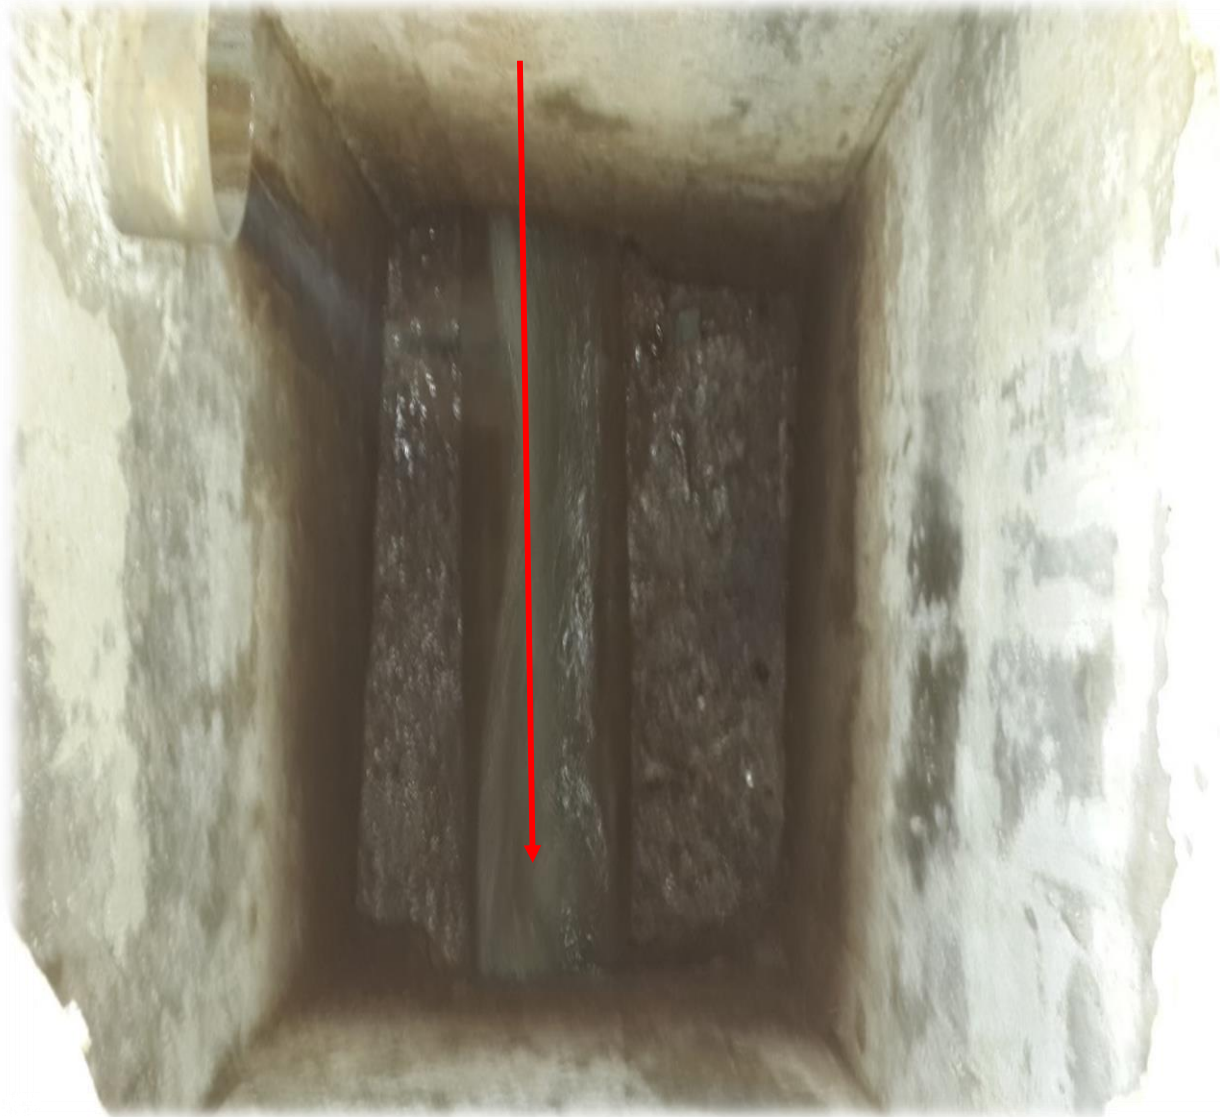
Le réseau d'assainissement Existant (Route Principale).
